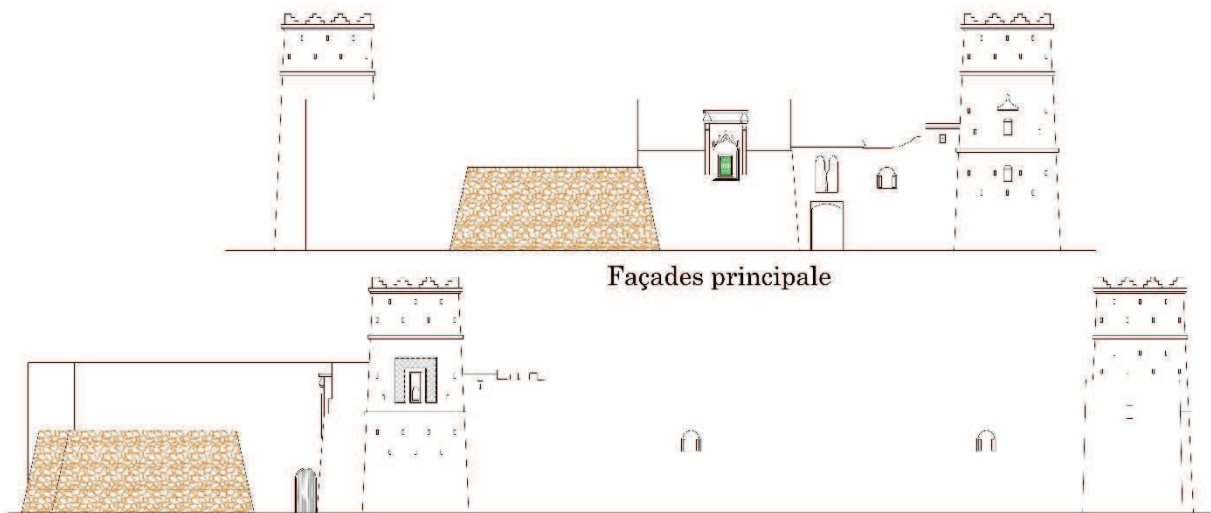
Façades de la Gasbah d'Ahl-Bellaameche, (échelle : 1/200).
